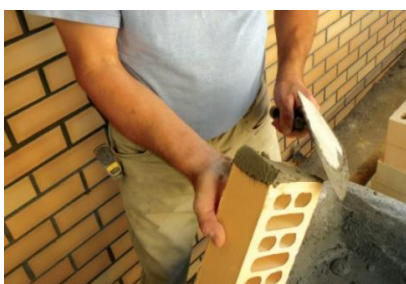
Aplicação de argamassa num topo do tijolo [43]
